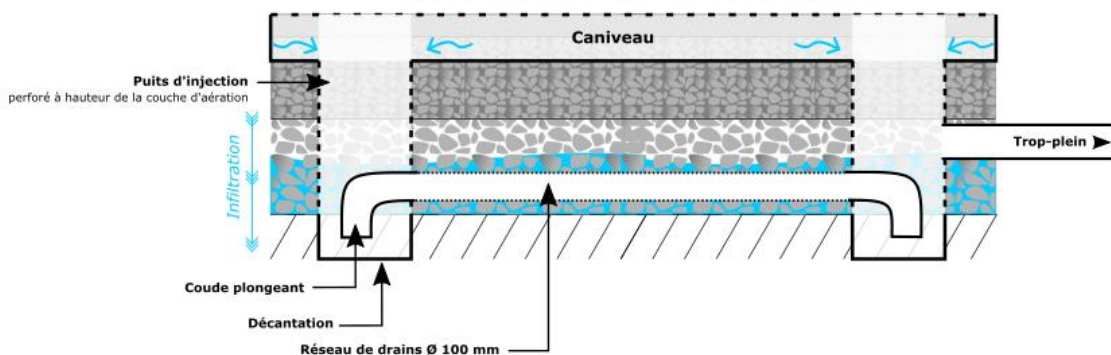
Coupe de principe d'une chaussée réservoir (source : FLOW-concept)
